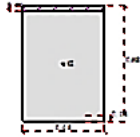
Section d'acier de la poutre (45x65) à mi- travée
